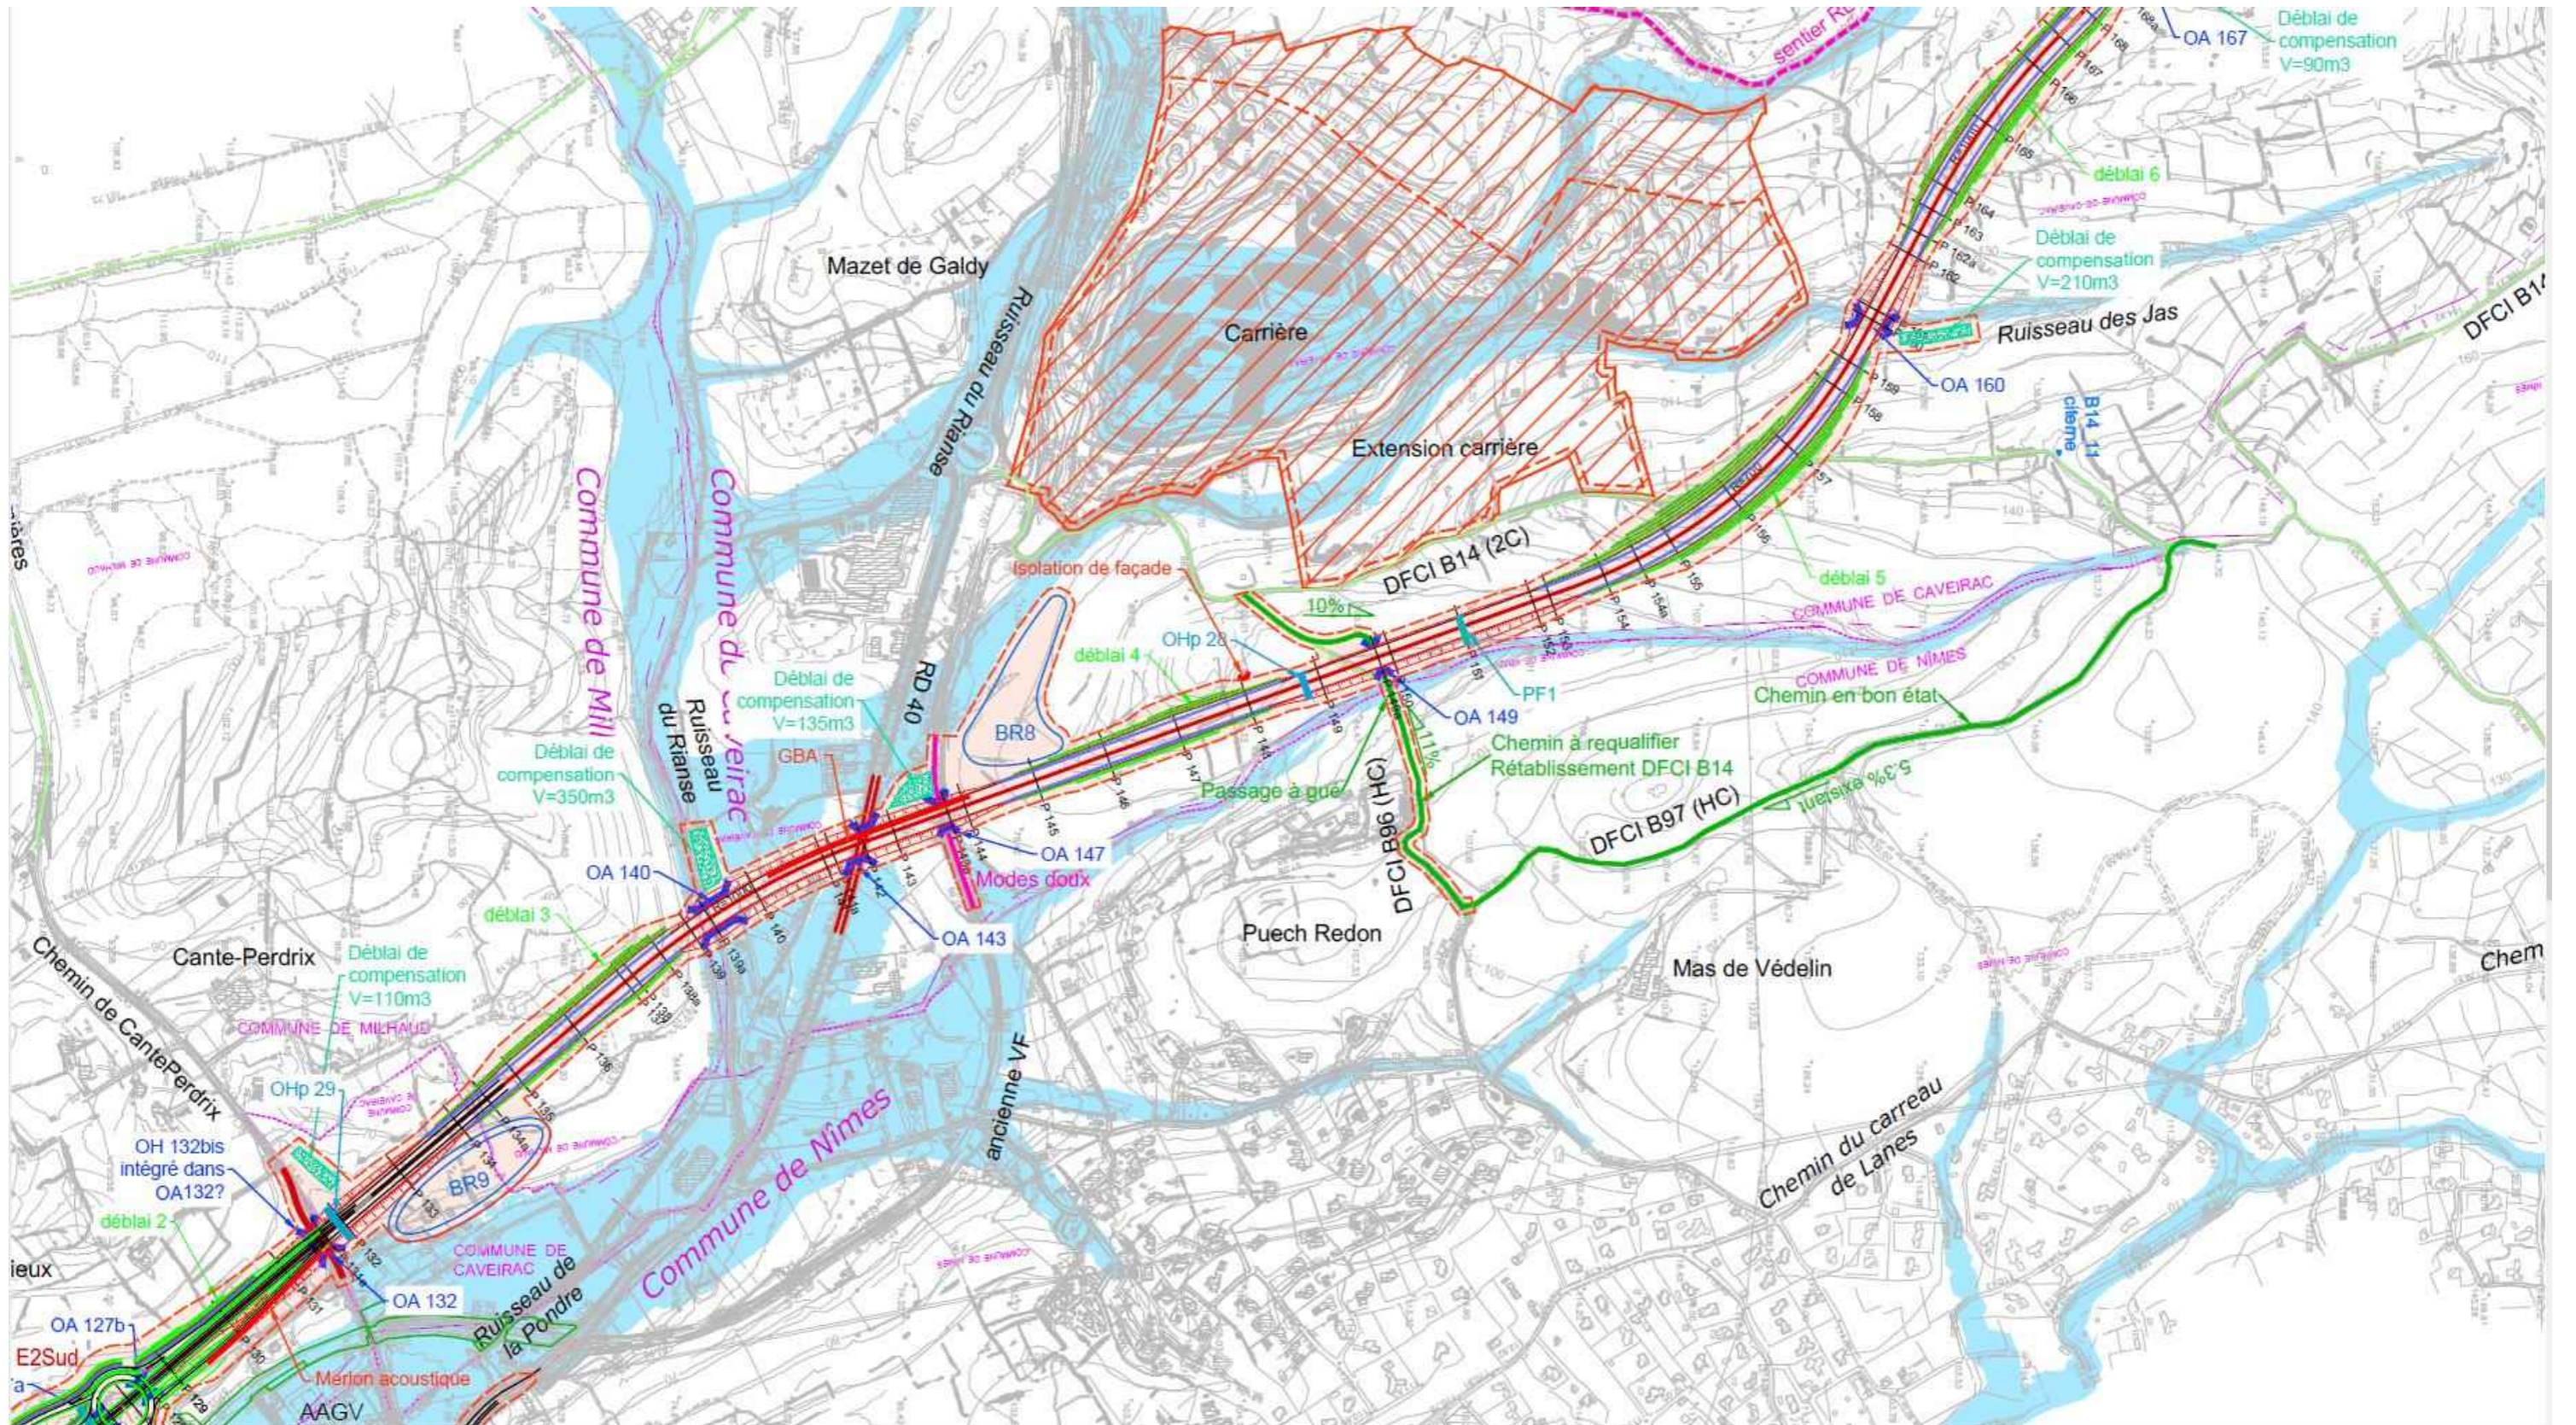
plan de masse du projet 3/4 (Source : Présents, juin 2021)
